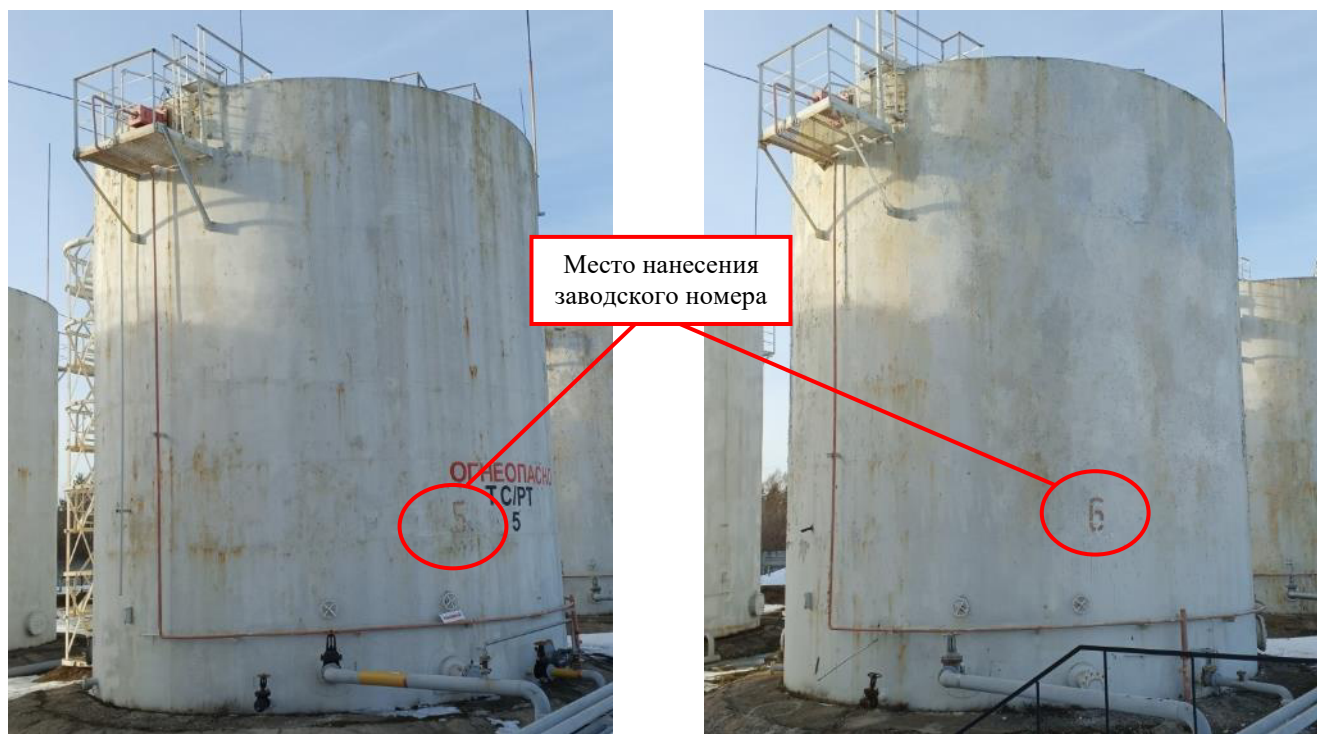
Общий вид резервуара стального вертикального цилиндрического РВС-1000 зав.№ 5, зав.№ 6
